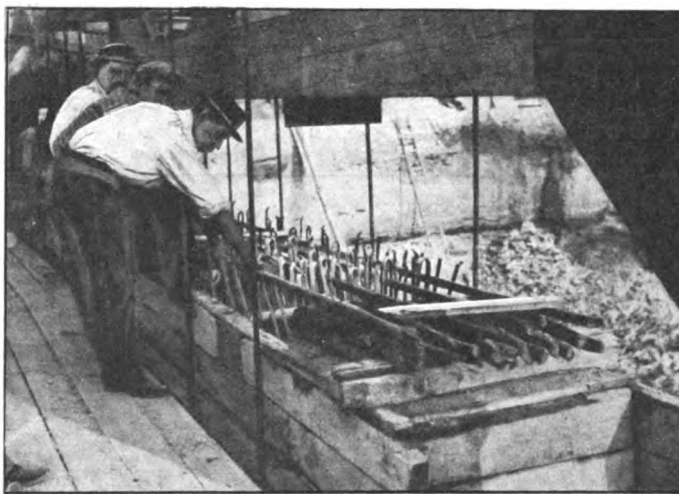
Exécution d'une poutre en béton armé sous le bâtiment des voyageurs de l'une des stations.
